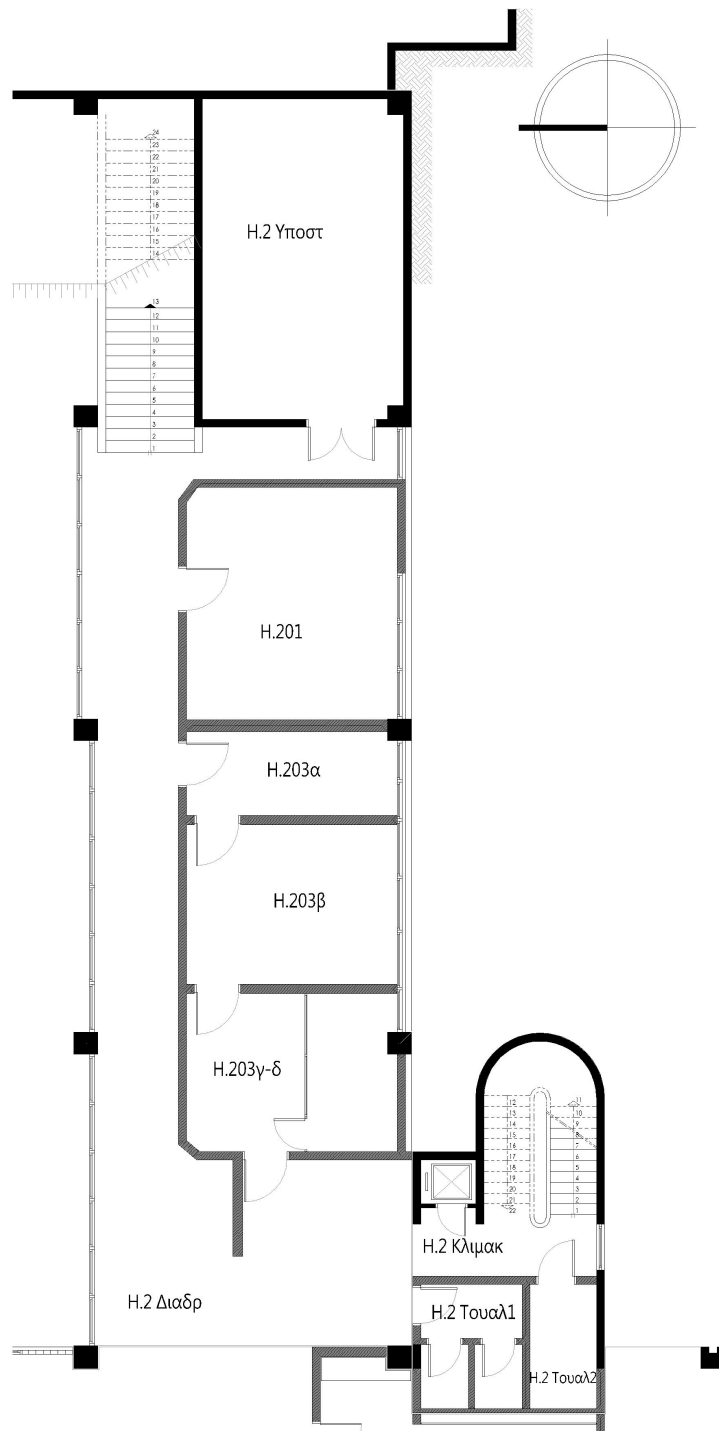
Κάτοψη πτέρυγες Δ-ΔΘ του επιπέδου 2
